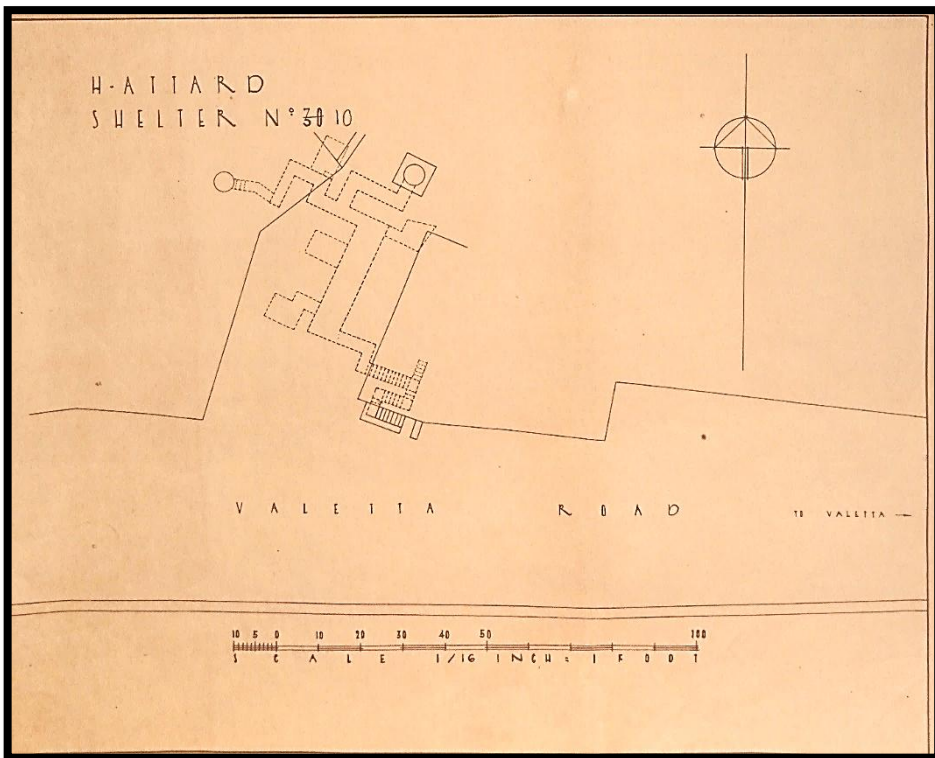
Planta do Abrigo nº10 (30) "Valletta Road"
